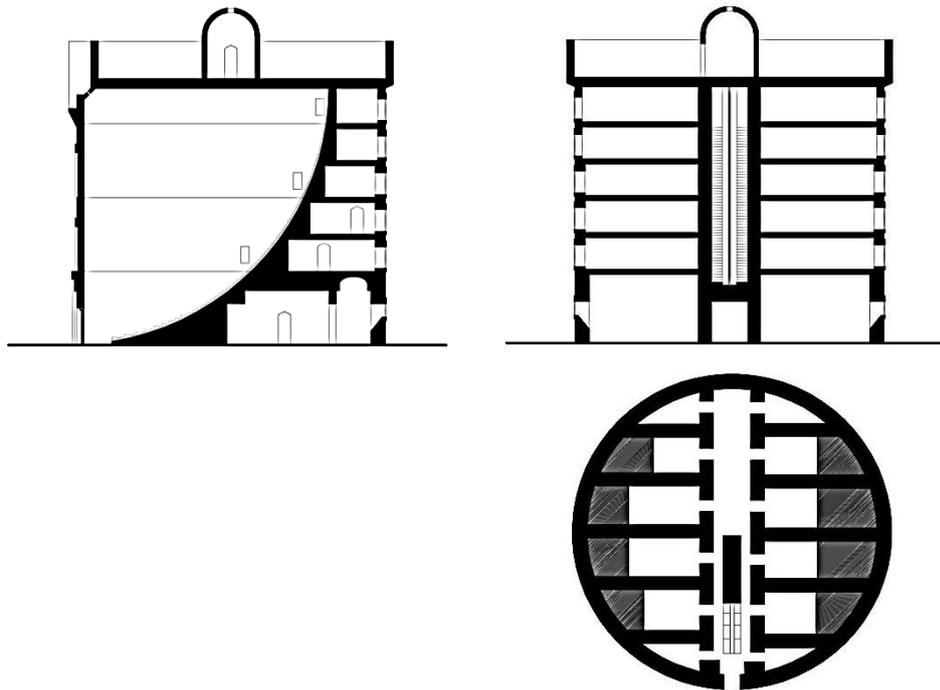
Observatorio de Maragha. Planta y secciones.
